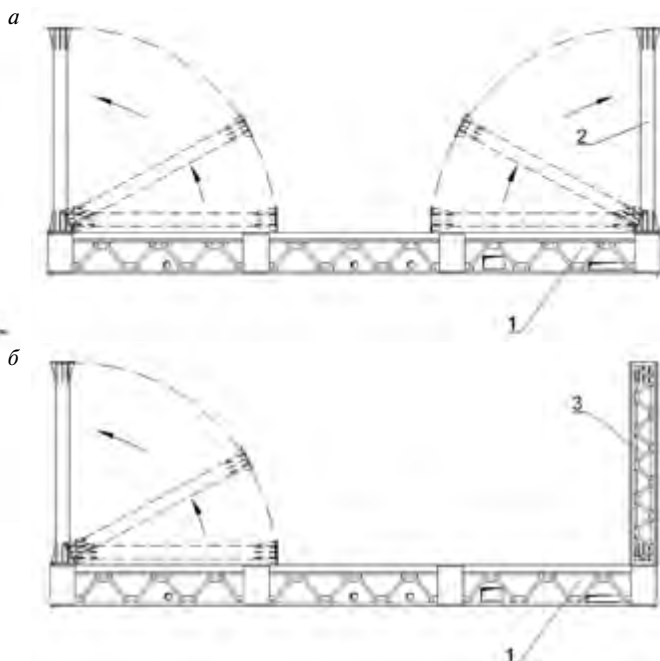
Объемный блок: а — блок с колоннами; б — блок со стеновым модулем; 1 — модуль перекрытия; 2 — колонна; 3 — стеновой модуль (наружное трансформируемое стеновое ограждение условно не показано)
